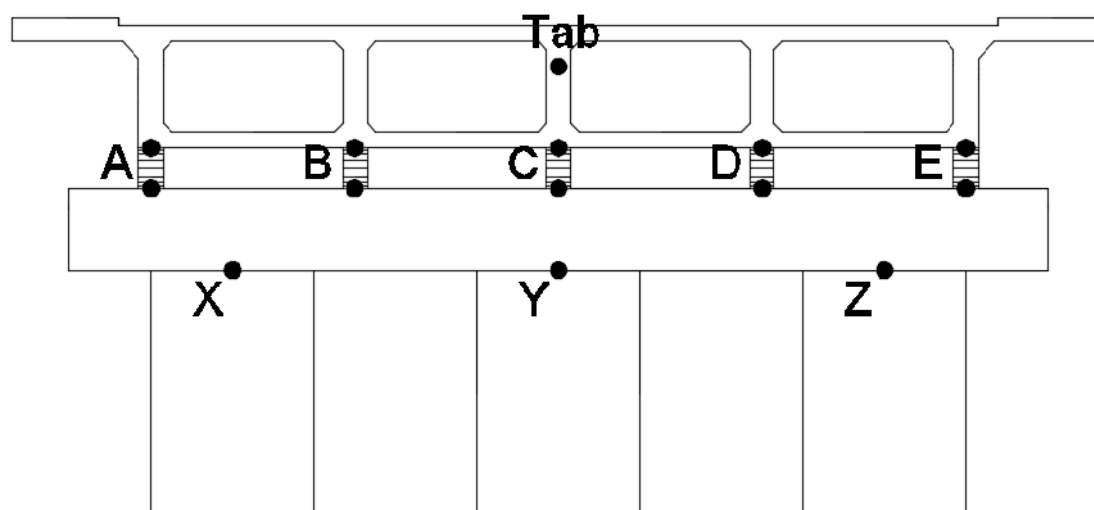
Sección de puente con aisladores (Fuente: elaboración propia)
